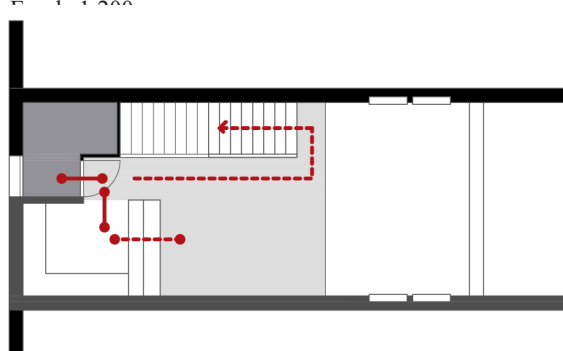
Organização piso inferior. Planta Escala 1:200.
